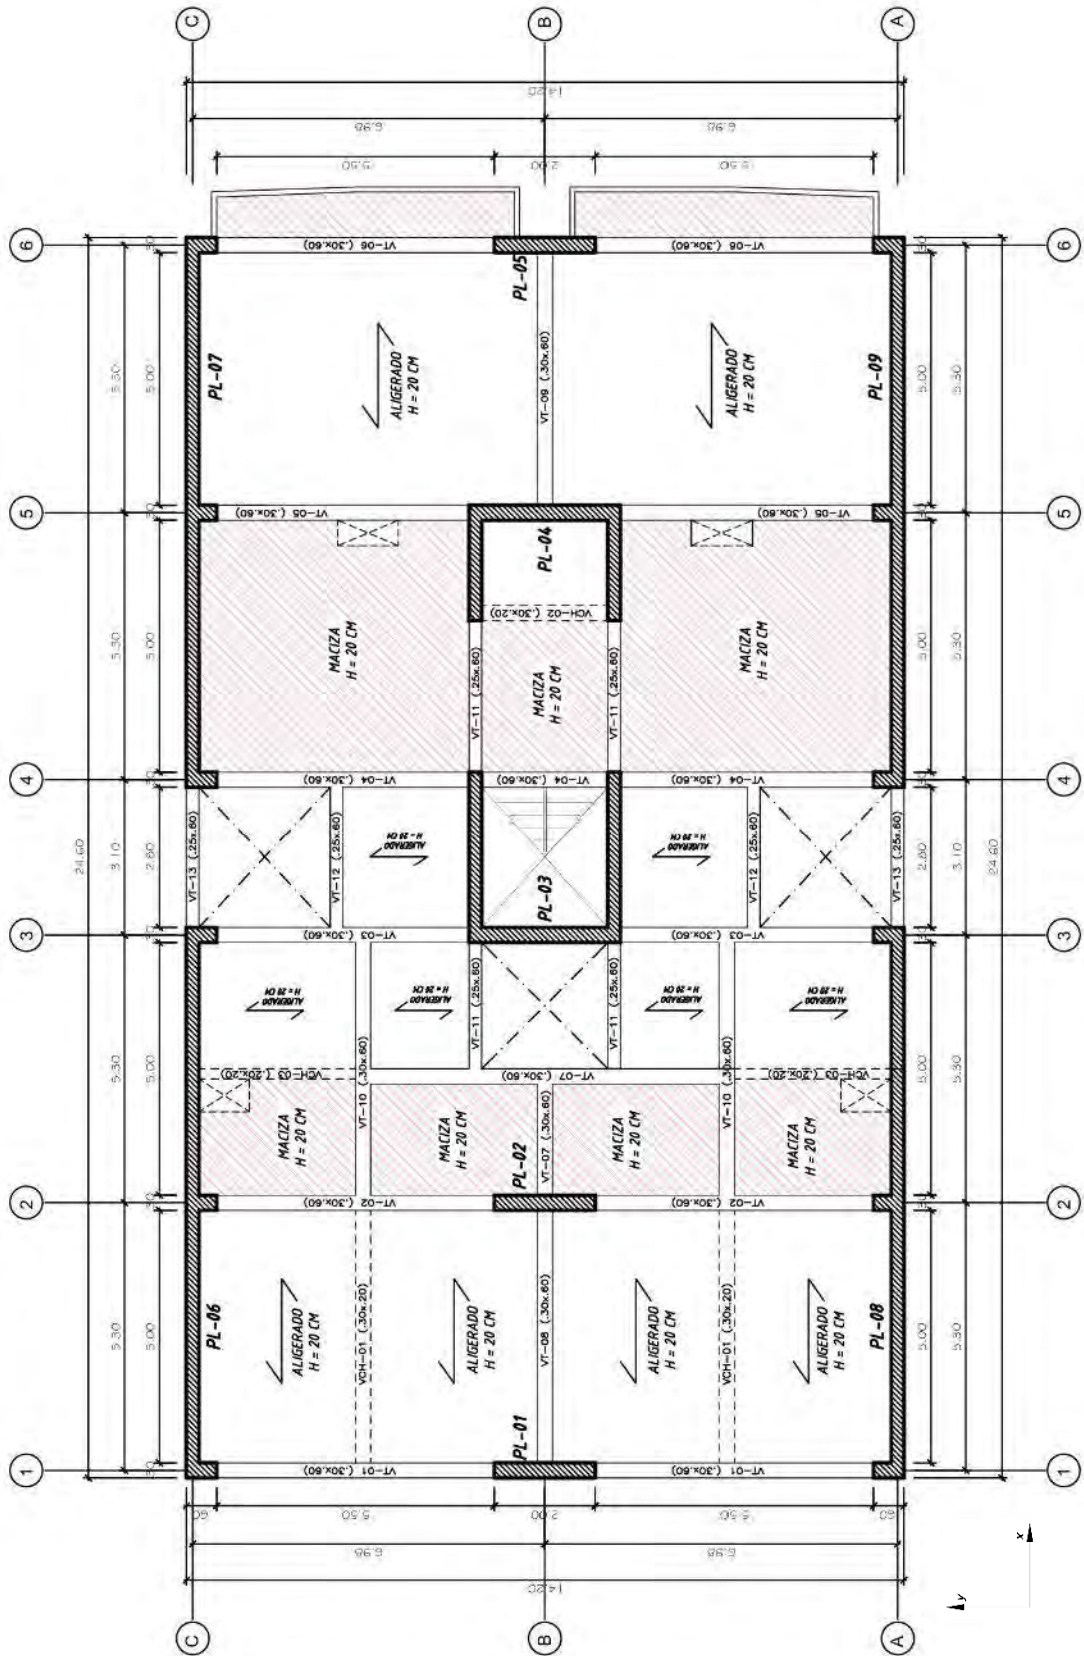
Estructuración y predimensionamiento de piso típico
